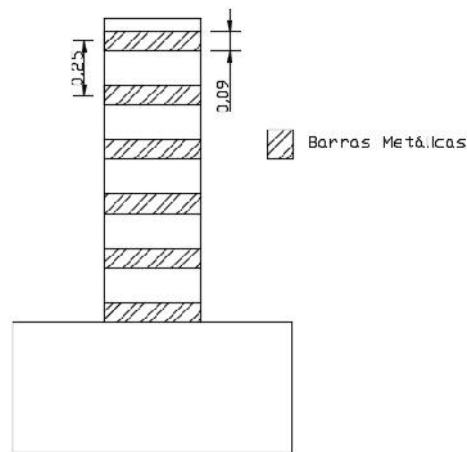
Exemplo de reforço com utilização de barras metálicas
